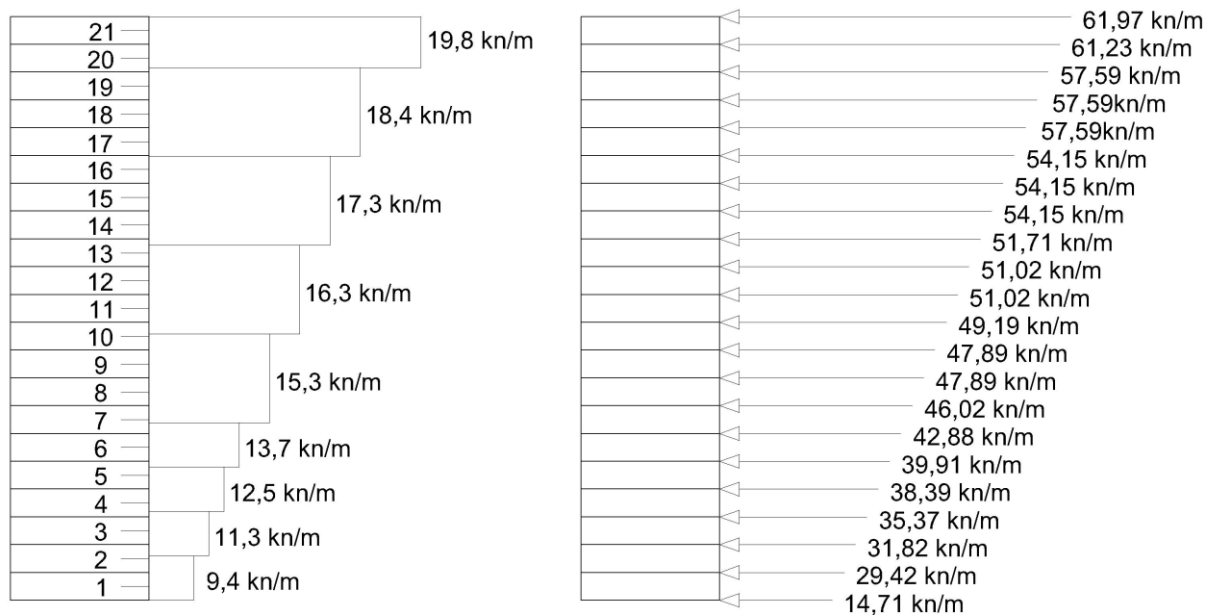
Cargas de vento distribuídas para cada pano de laje na fachada maior.
